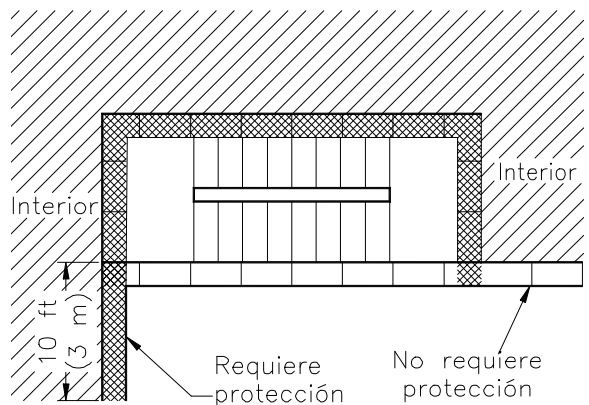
(a) Escalera con muro exterior no resistente en el mismo plano que el muro exterior del edificio.
